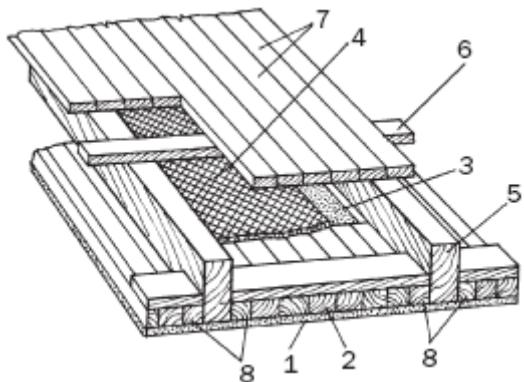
Перекрытия по деревянным балкам: 1 – гипсокартонные листы; 2 – щит перекрытия; 3 – гидроизоляция; 4 – звукоизоляция; 5 – балка; 6 – лага; 7 – доски пола; 8 – черепные бруски
